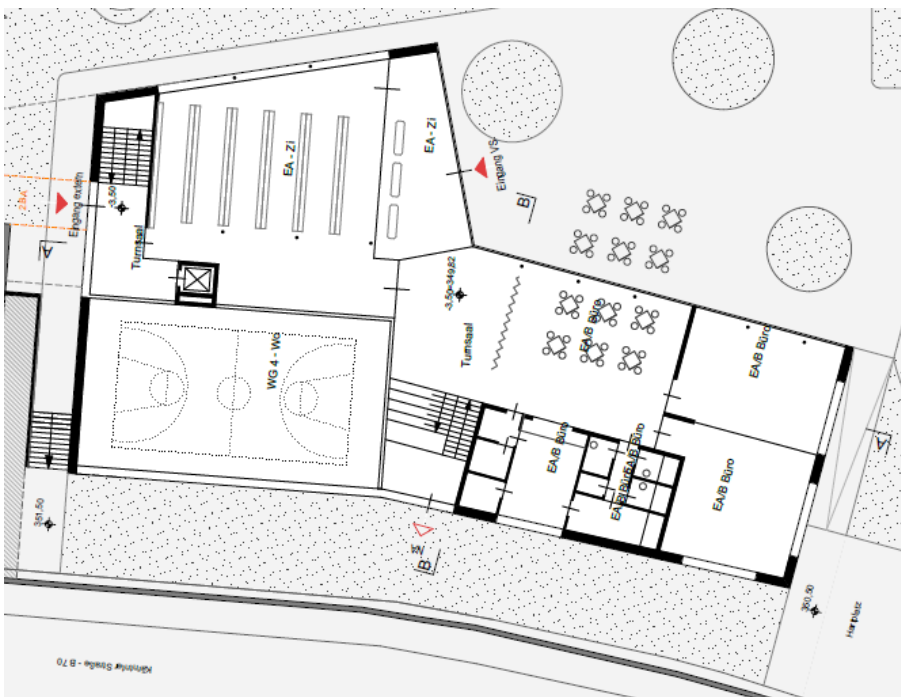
Grundriss Hofgeschoß - VS Straßgang - Zubau
